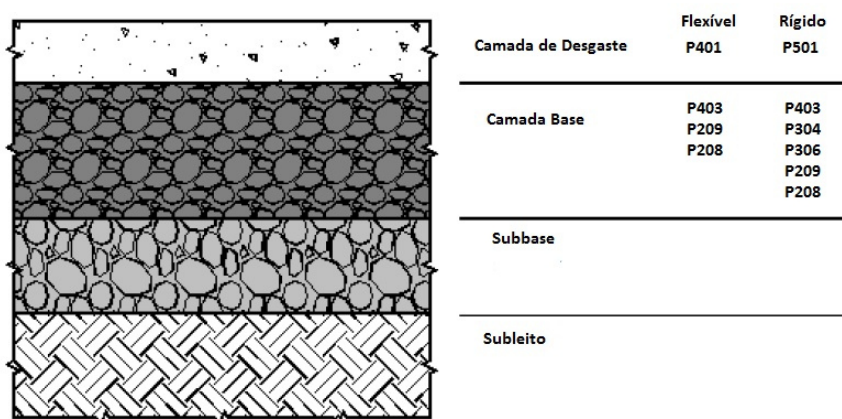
Estrutura típica dos pavimentos aeroportuários (Adaptado de FAA, 2016b)
